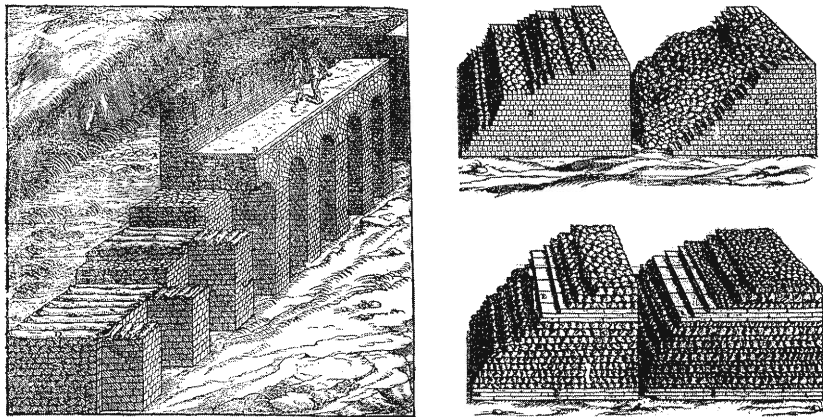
Interpretación del texto de Vitruvio sobre la construcción de murallas y muros romanos (Rusconi 1660).
